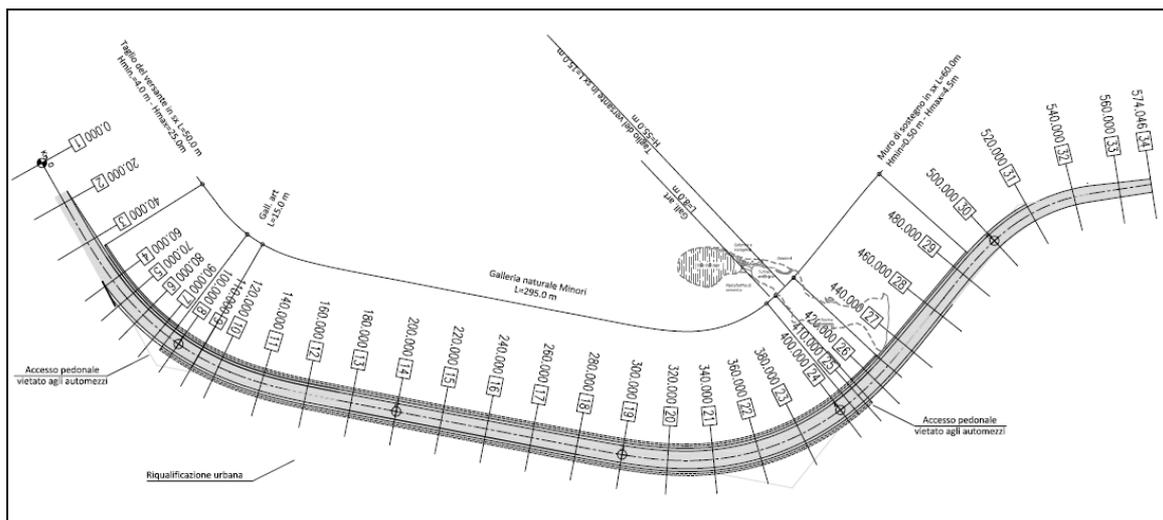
Planimetria *Alternativa 2*, con localizzazione della Grotta dell'Annunziata (n. 17).
